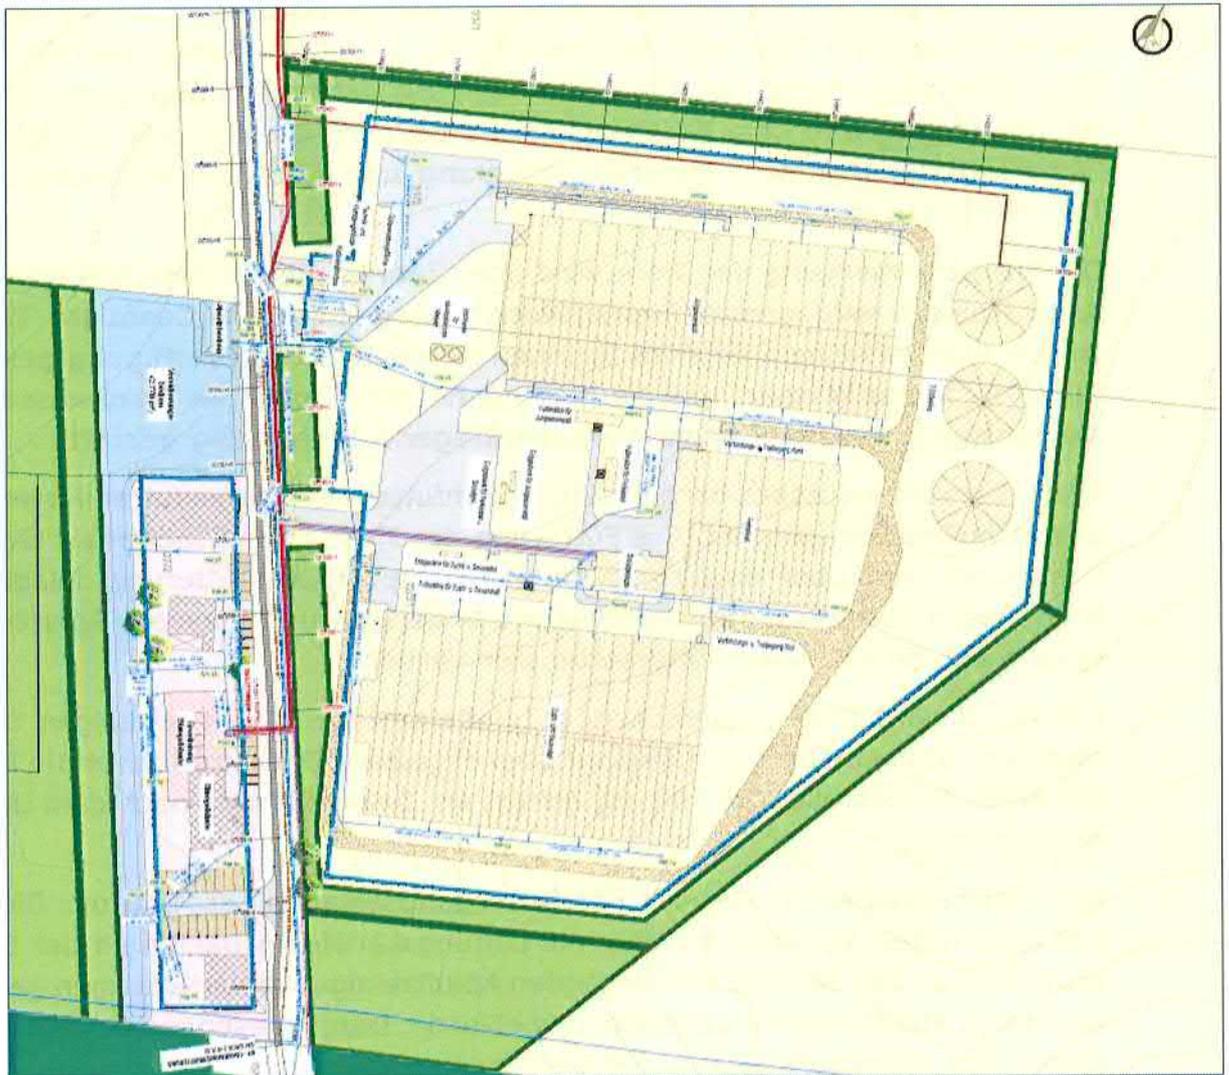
Geplante Stallanlagen, Darstellung nach dem Vorhaben und Erschließungsplan. Baukonzept Neurandenburg GmbH, August 2016 mit Ergänzungen April 2019, Januar 2020
